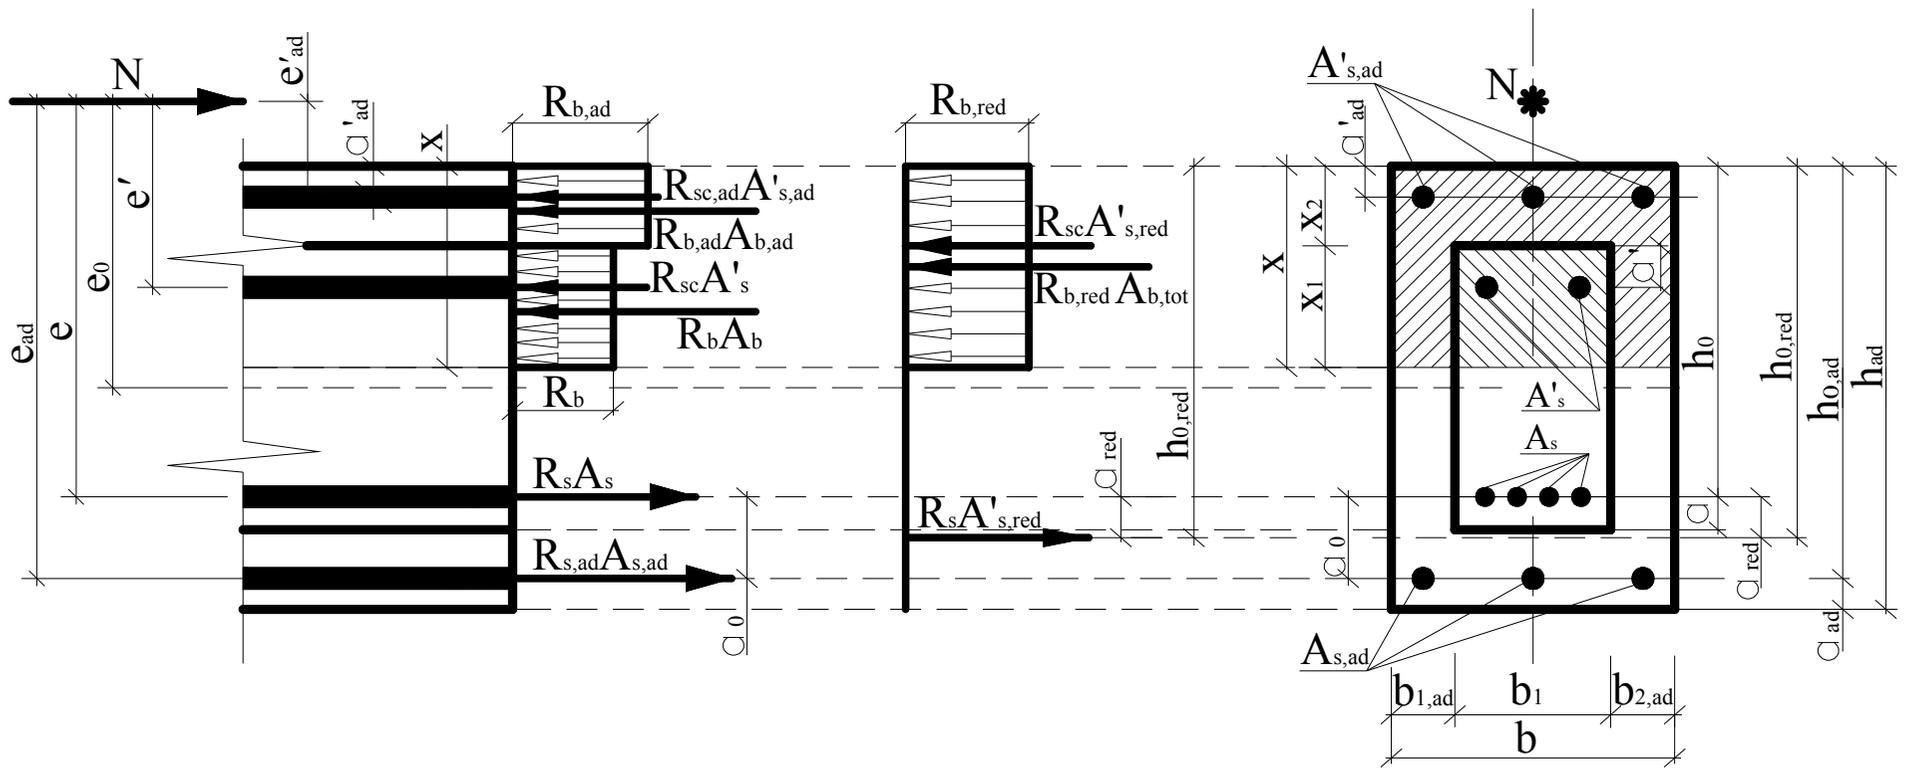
Расчетная схема и эпюры напряжений в нормальном к продольной оси сечении внецентренно сжатого элемента, усиленного обоймой (общий случай)
